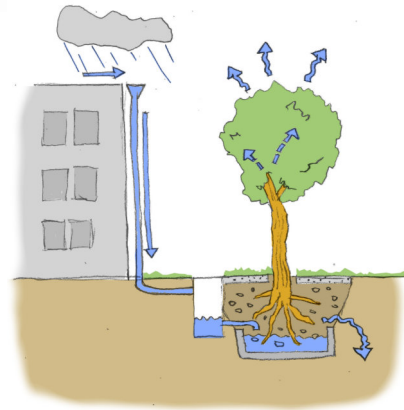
Unterirdische Einleitung von Dachwasser in eine Baum-Rigole mit oder ohne zwischengeschaltetem Verteilerschacht (TUD 2025 nach BlueGreenStreets Teil A 2022: 112, Abb. 87).
